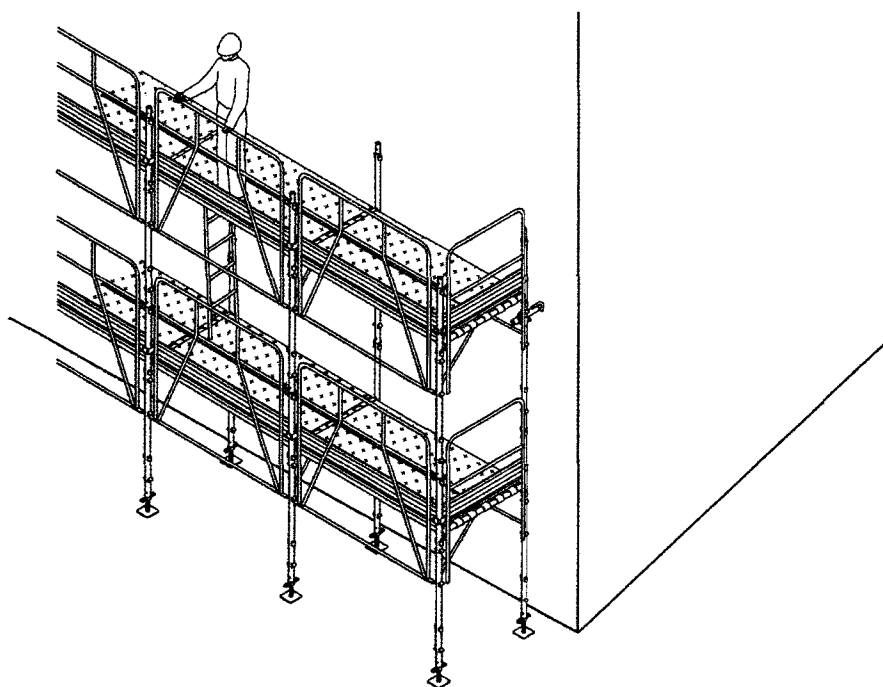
Fasi di montaggio dal basso del ponteggio con parapetto di protezione collettivo
